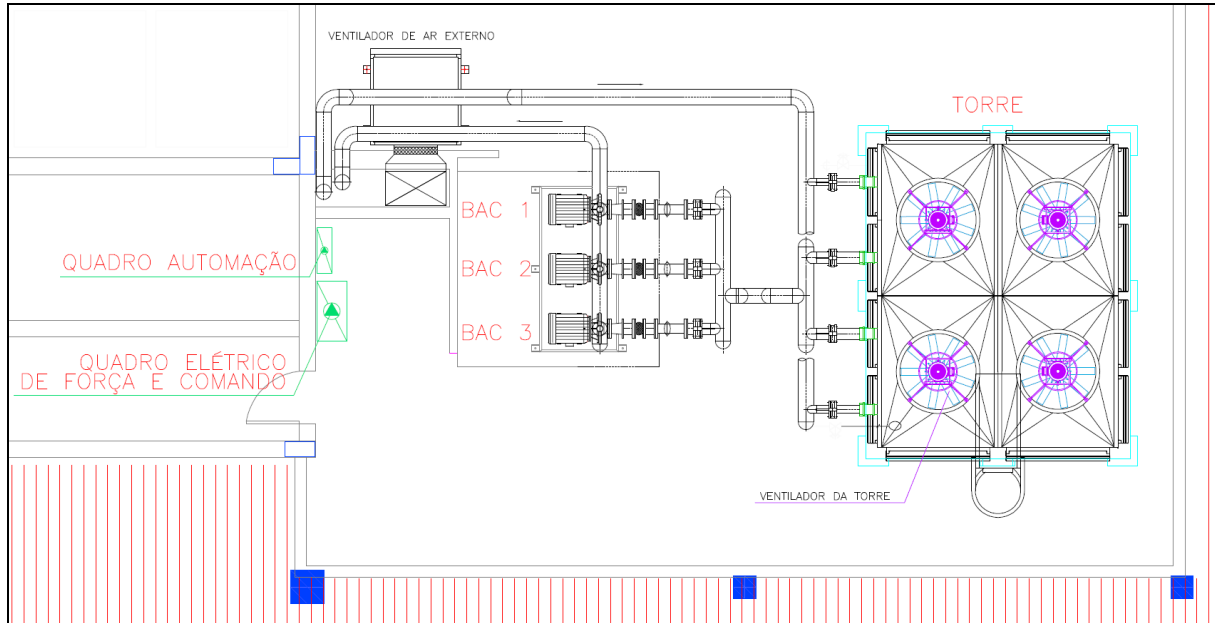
Layout da instalação dos equipamentos na Cobertura
